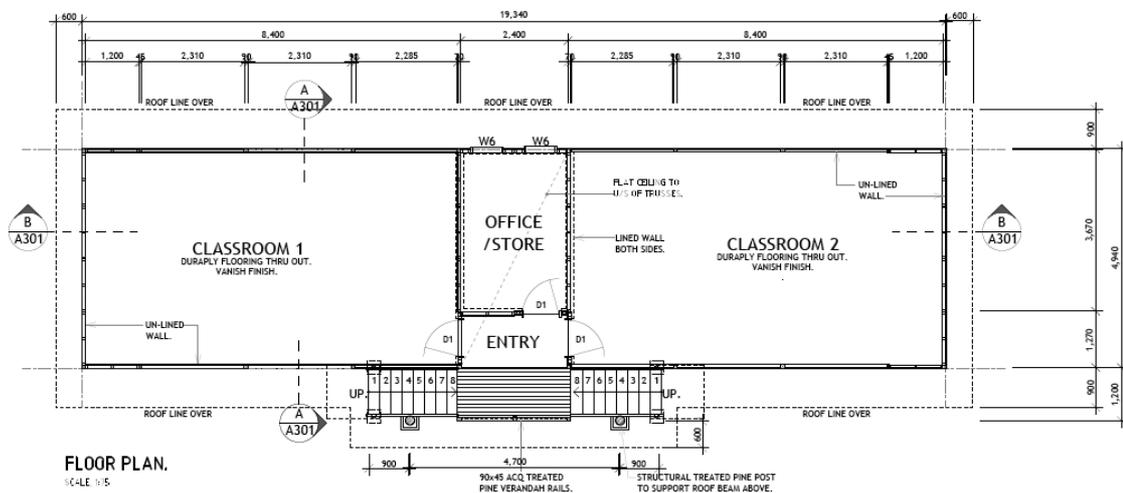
Grundriss des Doppelklassenzimmers (Quelle: *PNG Forest Products*, 21.06.2016)
